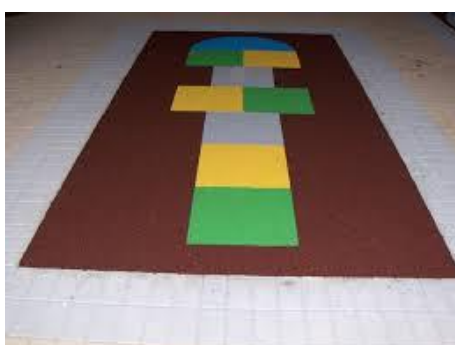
Planta de Pavimento – Área Muro Amarelo
